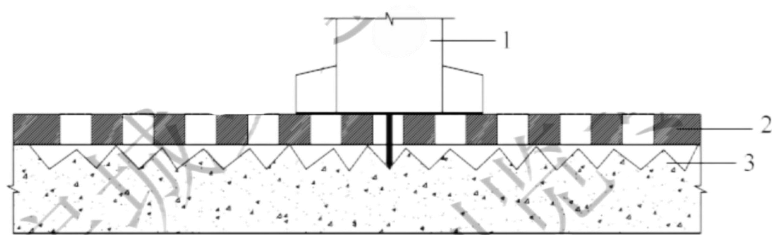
预制混凝土构件结合面粗糙度检测示意
